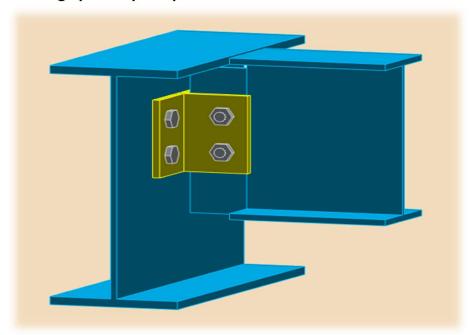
3D d'assemblage poutre-solive (IPE400-IPE270)
